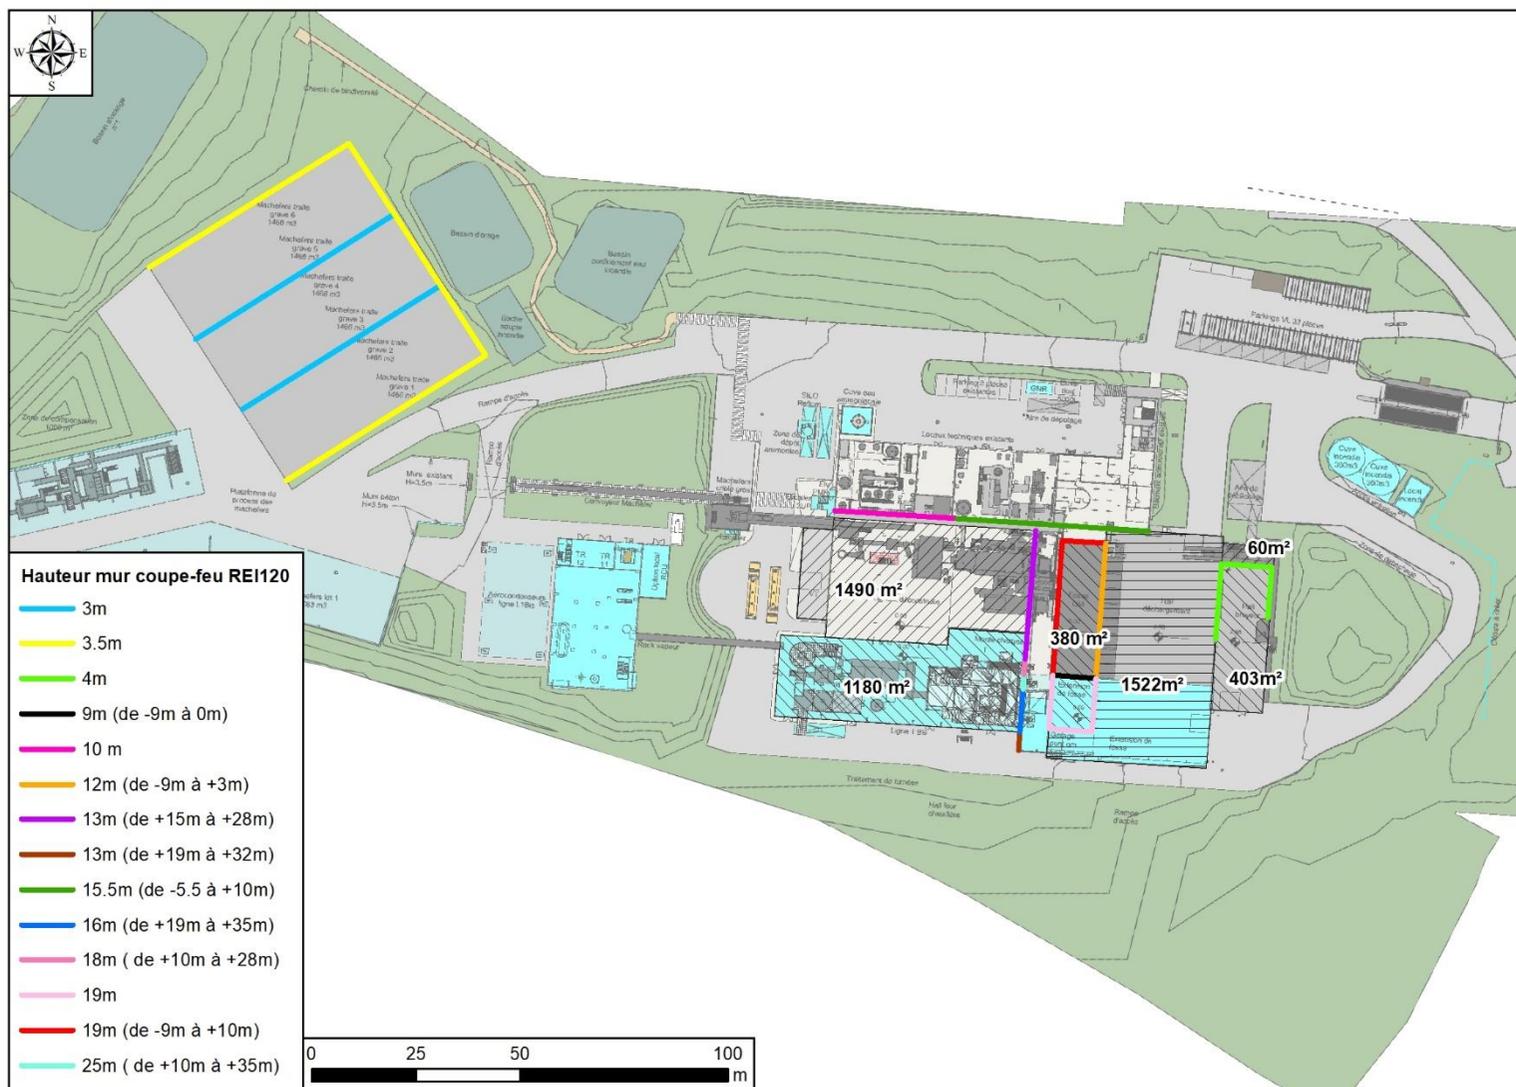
Plan d'ensemble de localisation des murs coupe-feu REI120
